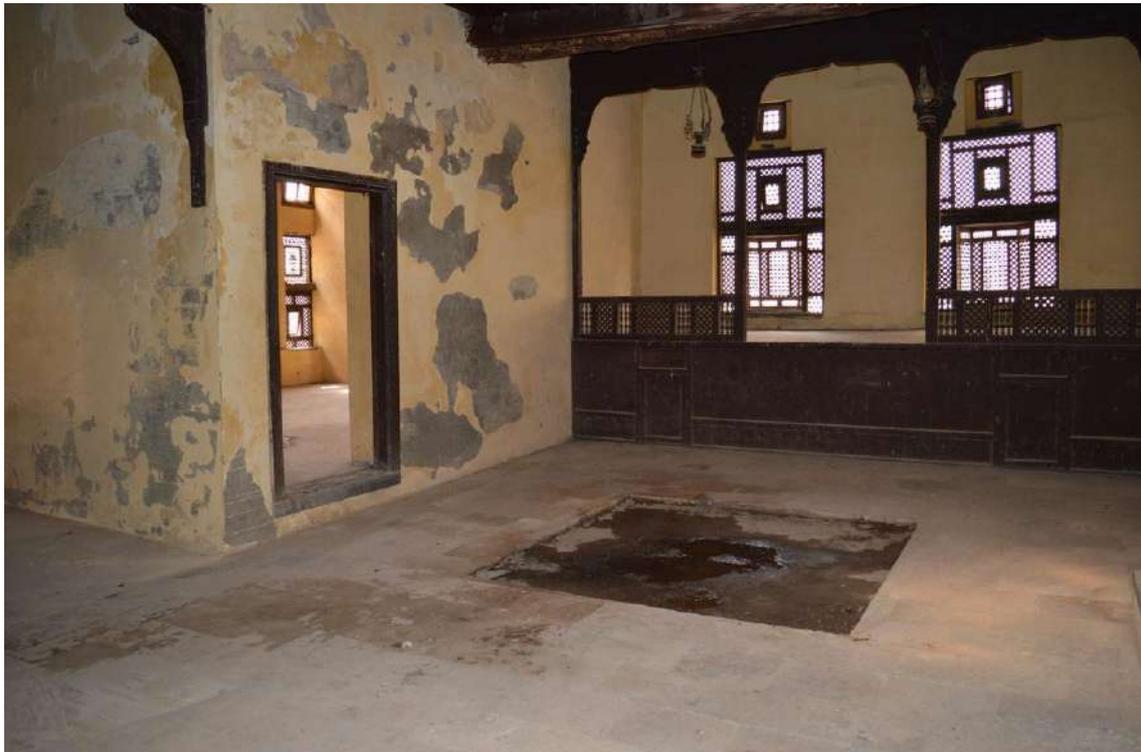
Ingresso dell'acqua piovana dal lucernario privo di tetto
